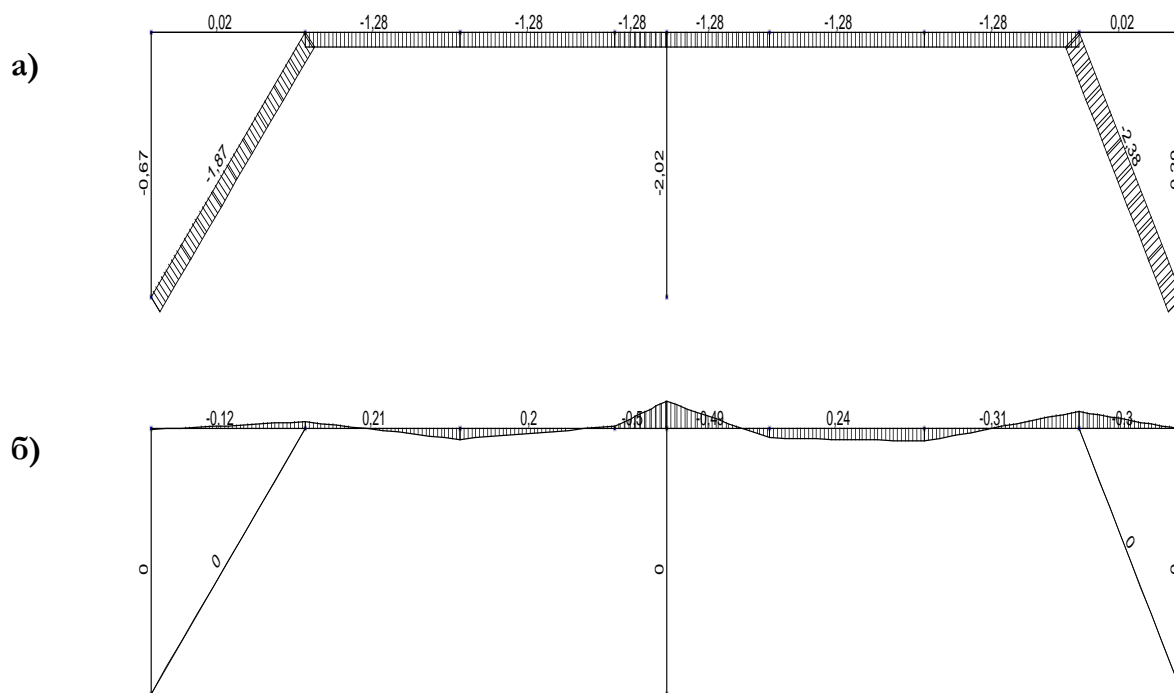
Эпюры внутренних усилий в поперечных сечениях продольной рамы по ряду Б от расчетных значений нагрузки: а) эпюра продольных сил N , $кН$; б) эпюра изгибающих моментов M , $кН \cdot м$;
